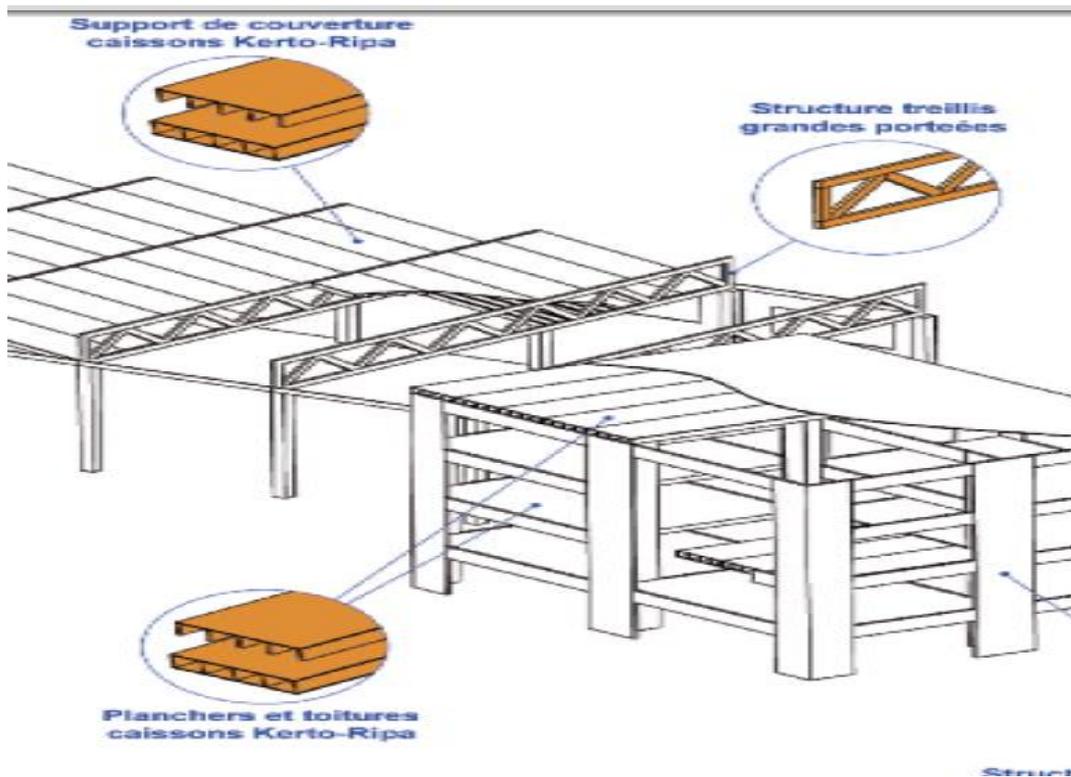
vue sur l'emplacement de caisson *poutre treille, plancher et toiture
